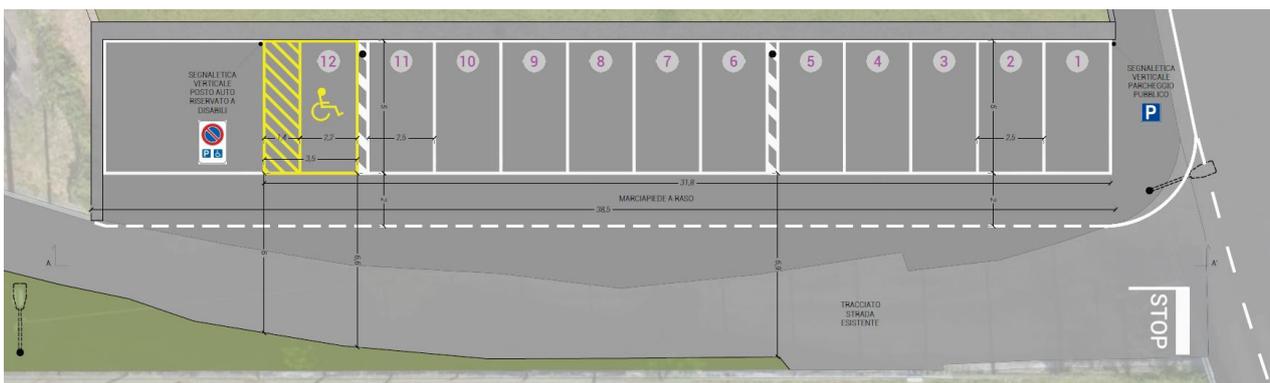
Estratto da All. EA_c_03_R2_Stato di progetto
